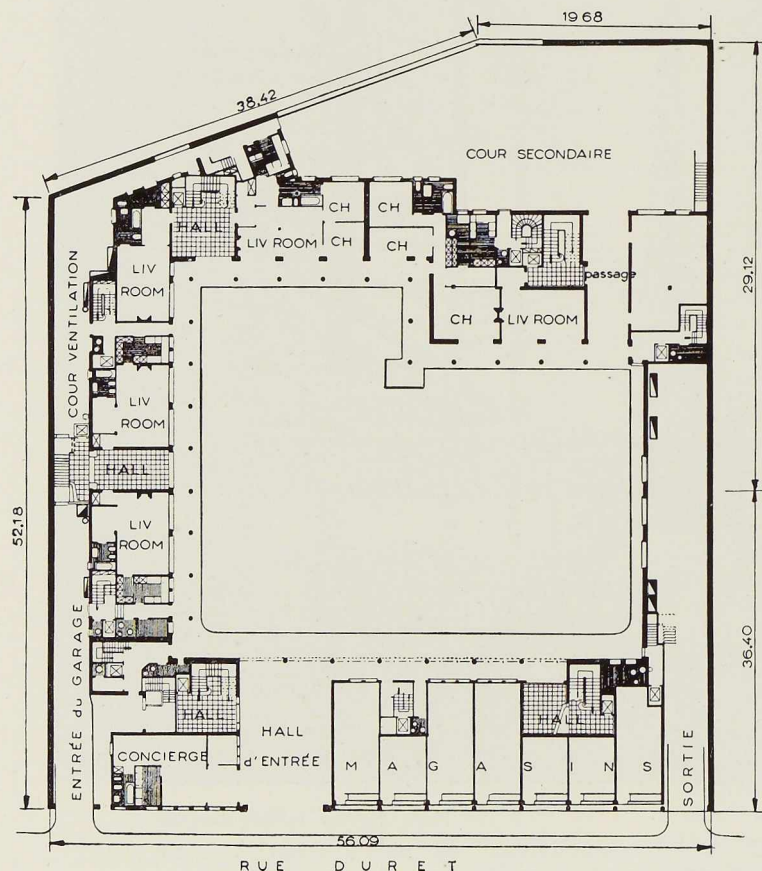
Plan du rez-de-chaussée. Le bâtiment donnant sur la rue Duret comporte sept étages, celui sur la cour en compte huit.
